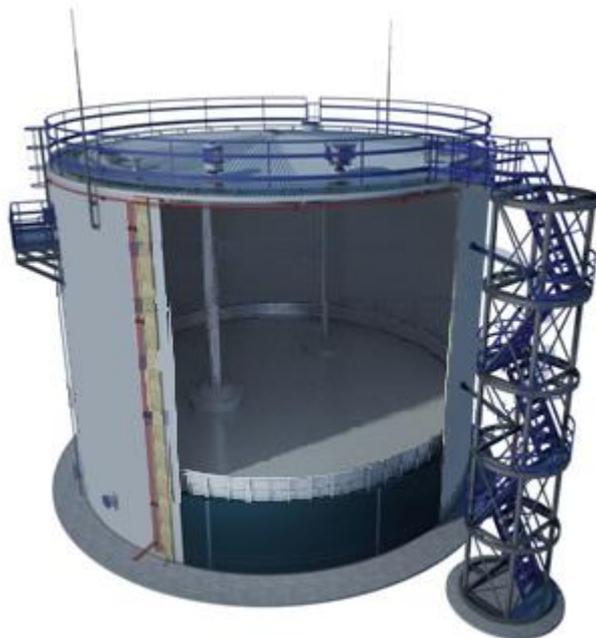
Резервуаров с плавающей крышей и плавающими понтонами
